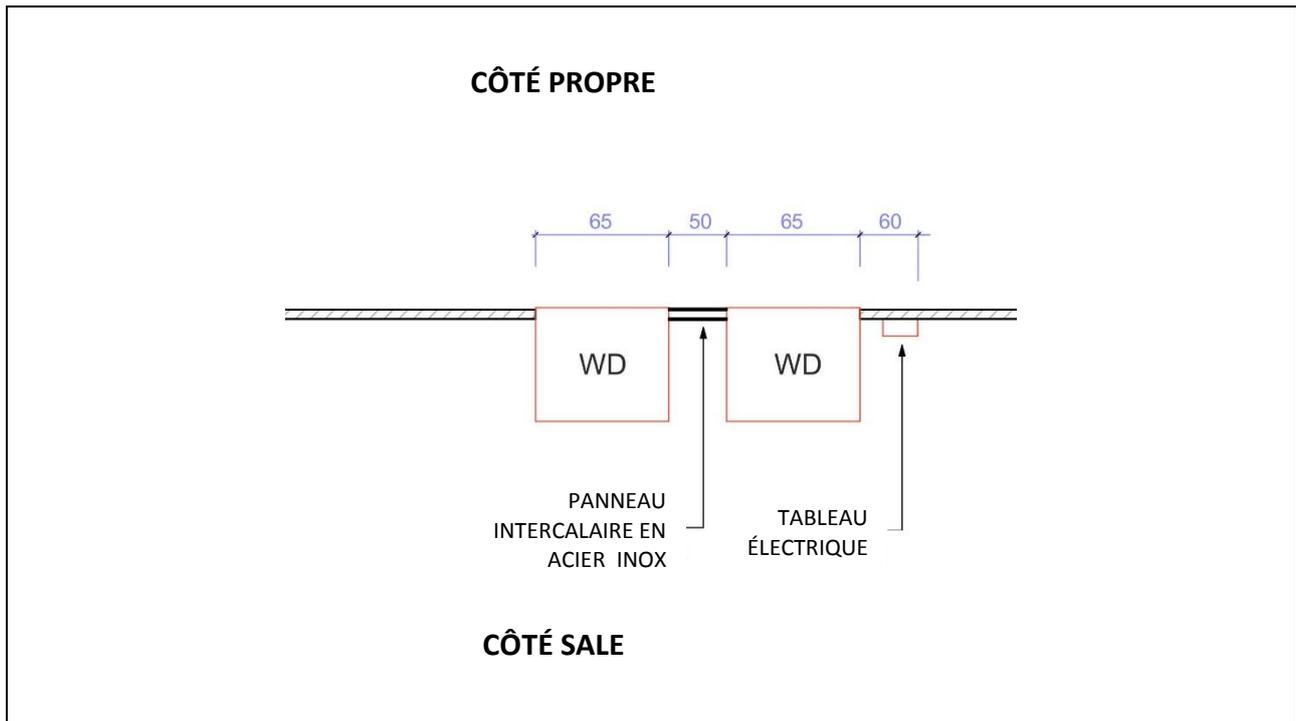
Exemple de positionnement en “montage mural” de deux appareils.
